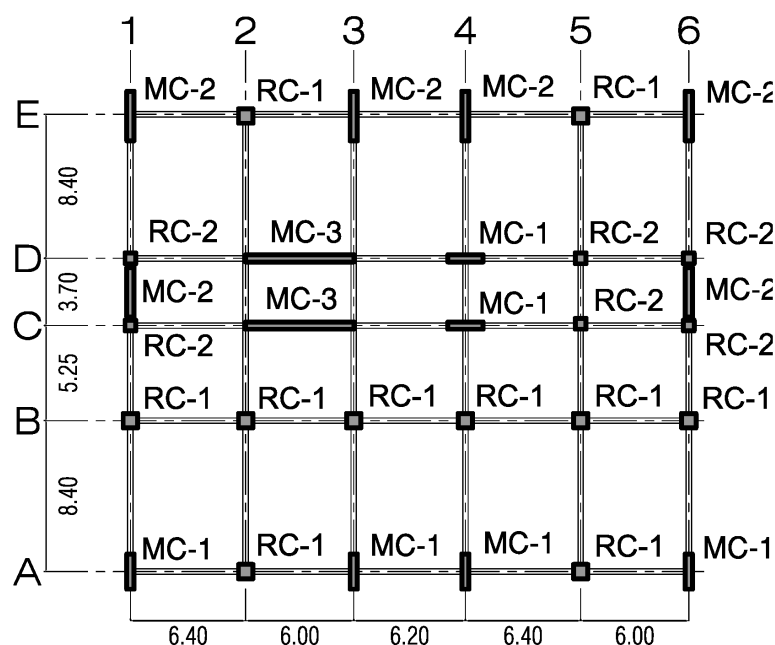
Distribución de elementos estructurales en planta para EDCR.
